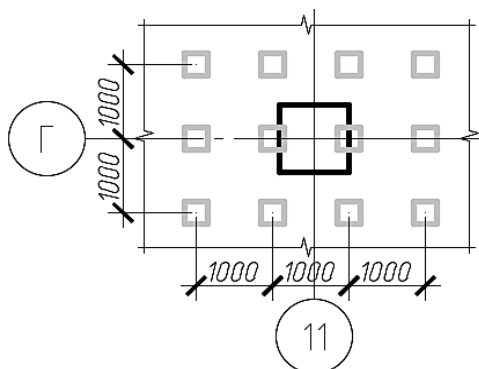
Схема розташування паль під фрагмент плитного фундаменту
